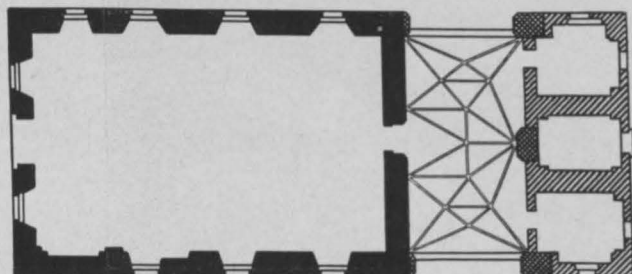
Fürstenwalde. Grundriß des Rathauses. Erdgeschoß.
